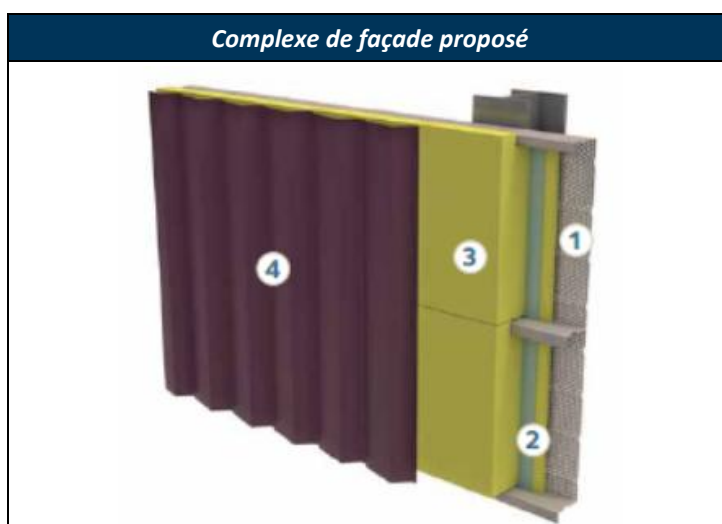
Complexe de façade proposé pour la création d'un bâtiment technique ATAWAY
